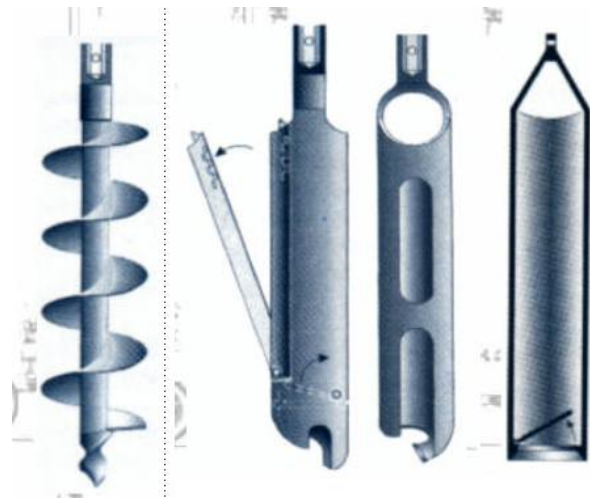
Spiralbohrer – Schappe - Ventilbohrer
